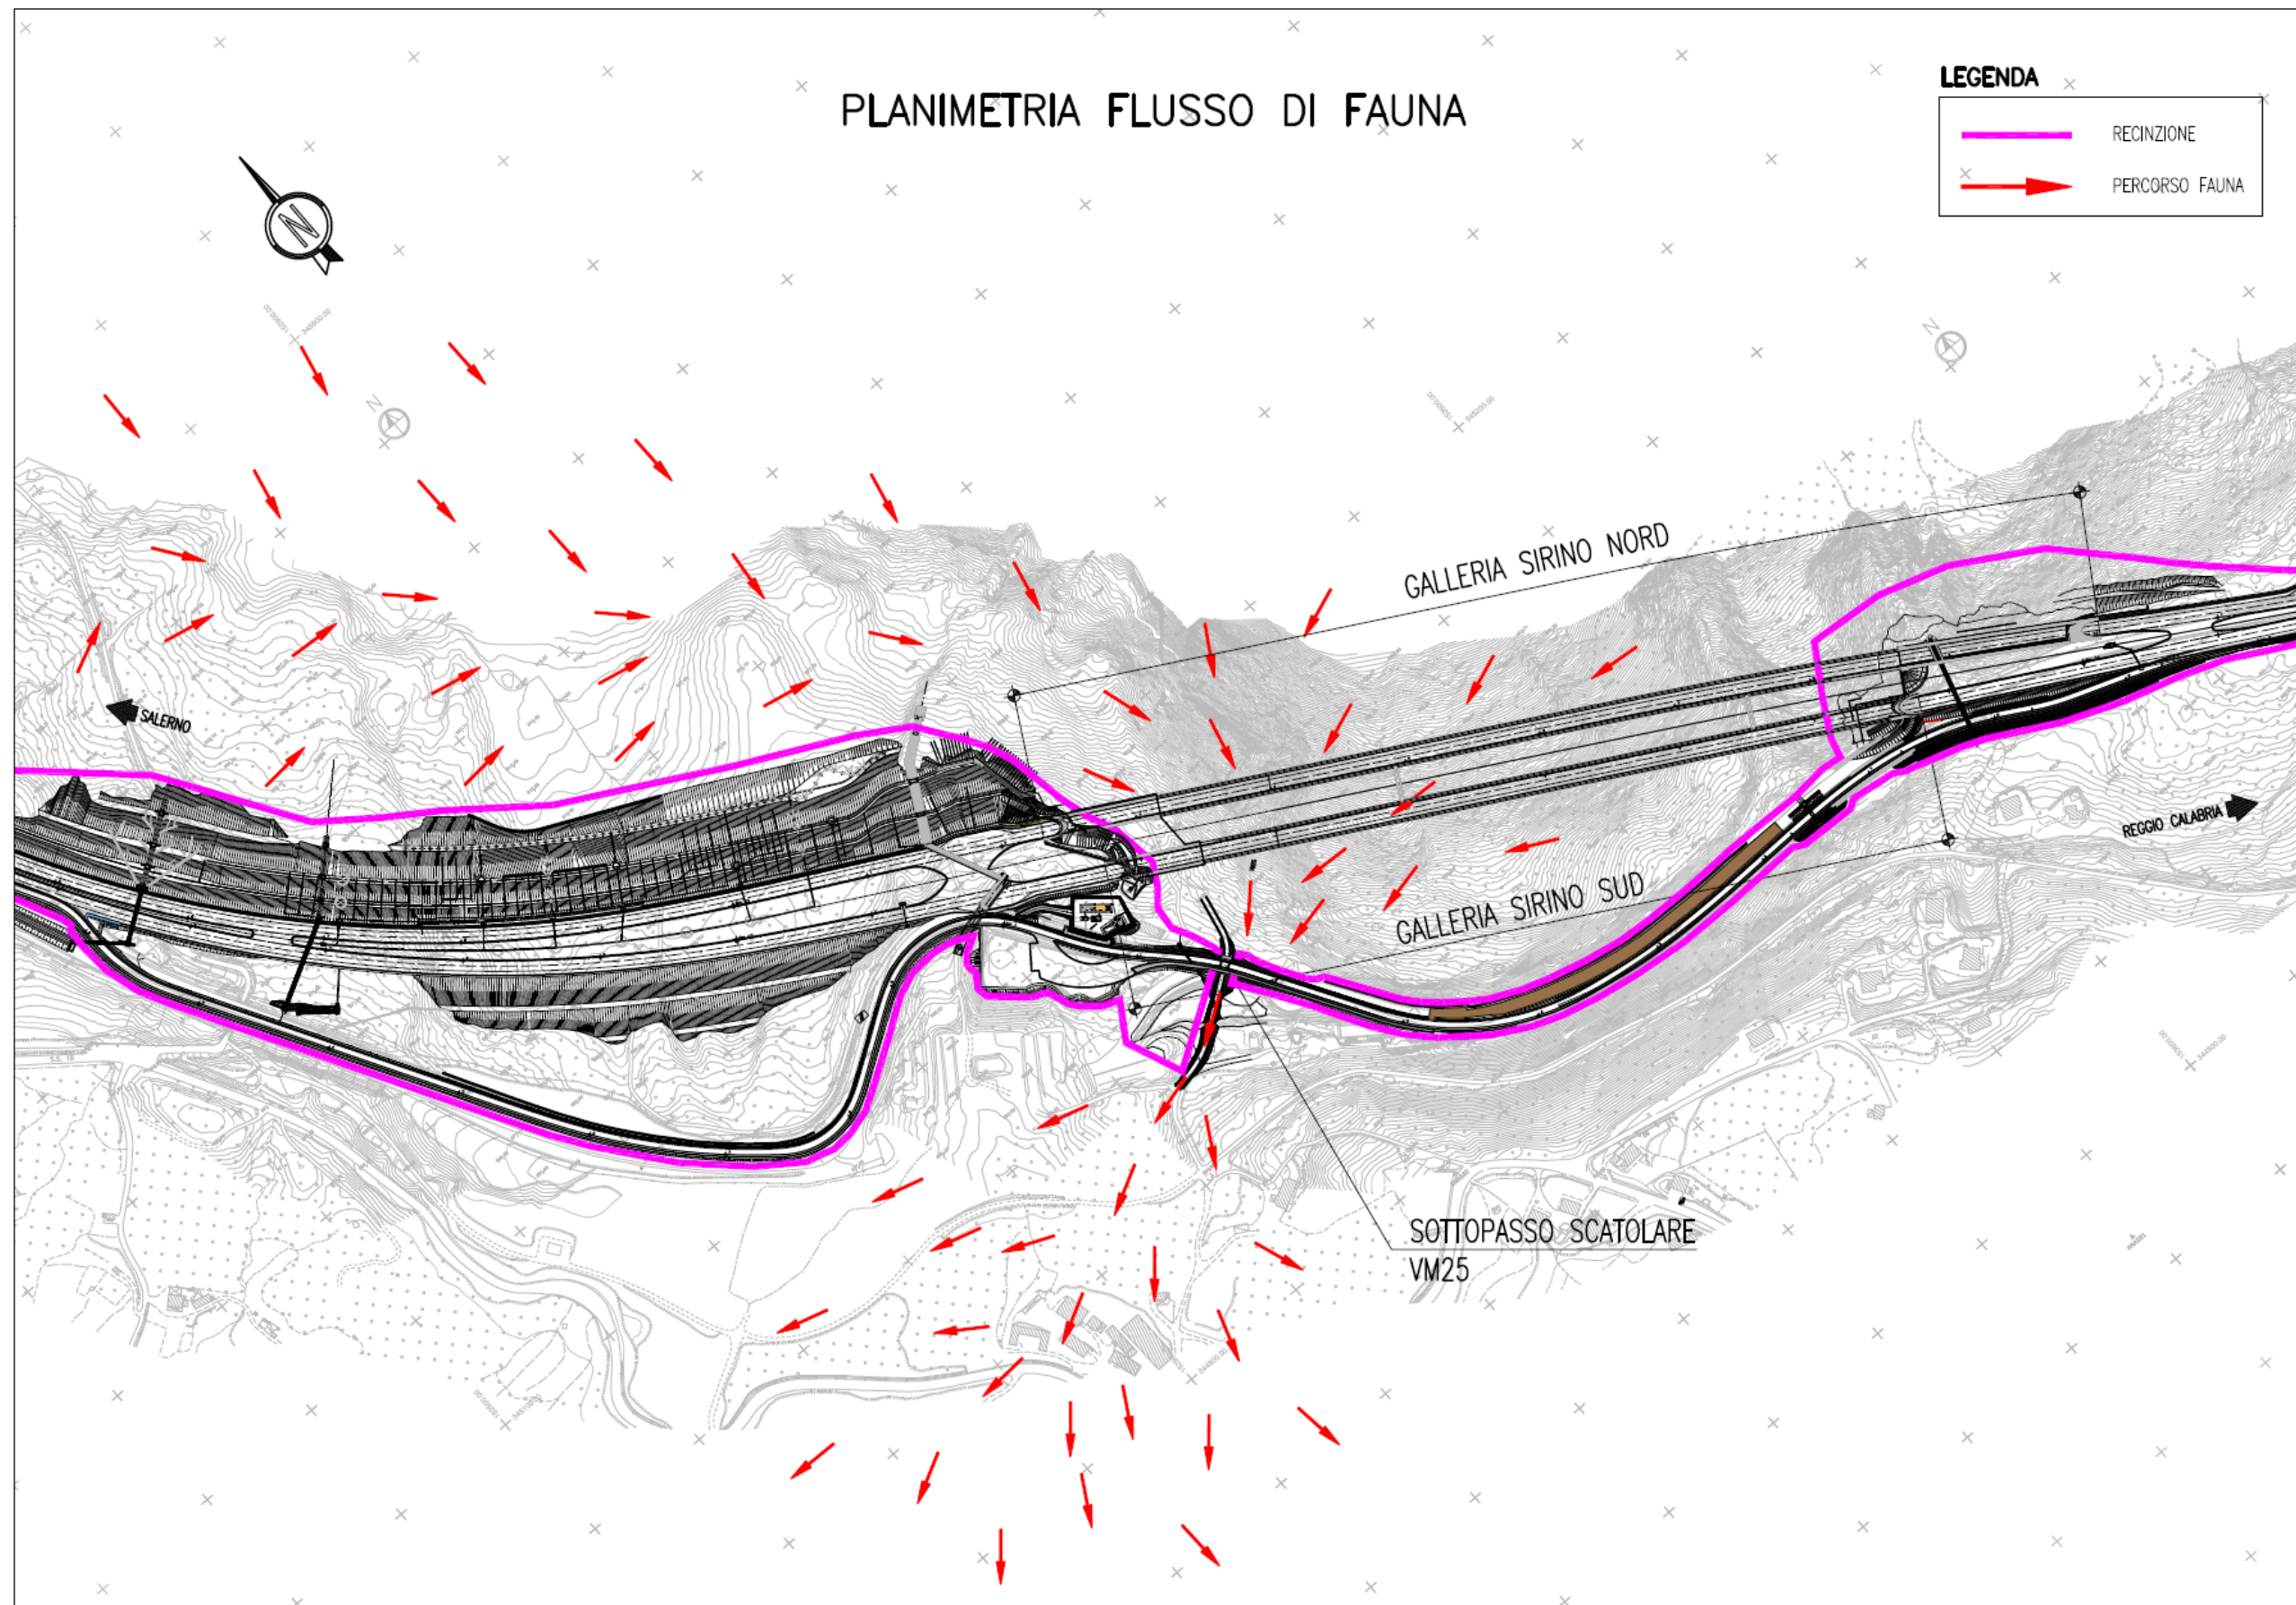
Planimetria flusso di fauna – Proposta di Variante
